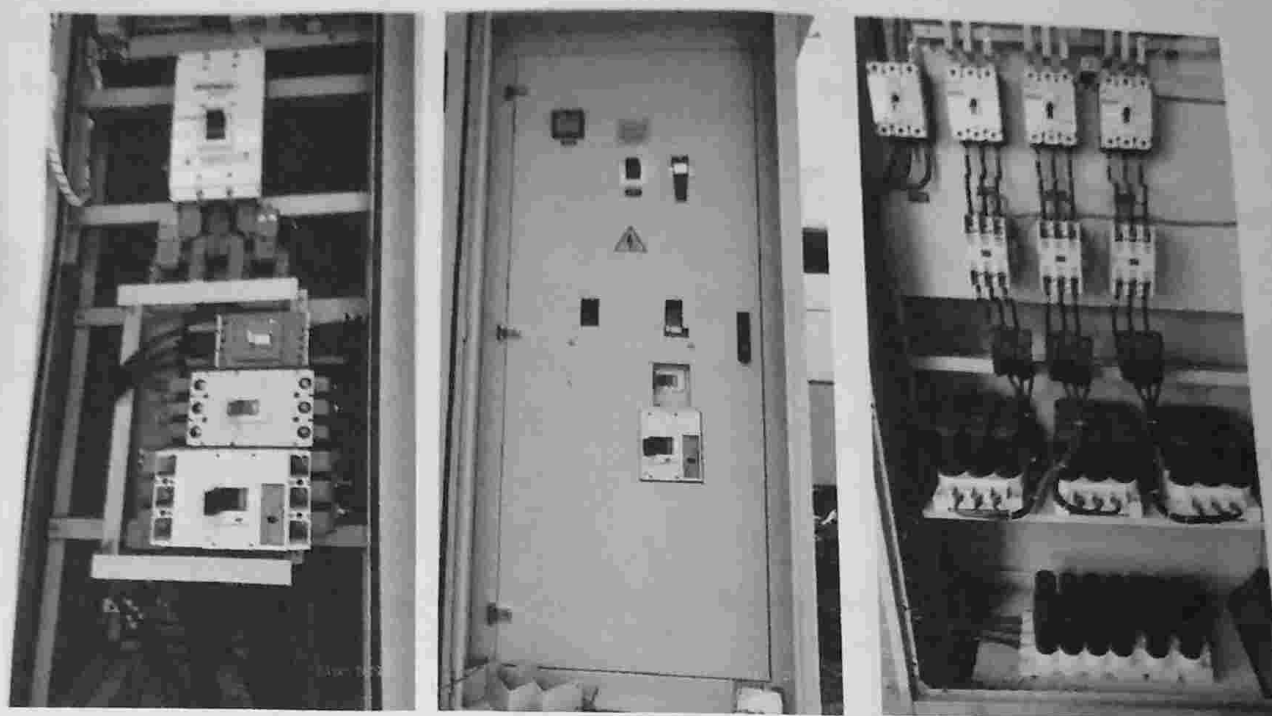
Tablero baja tensión Pediatría, Banco condensadores S.E cortijo
